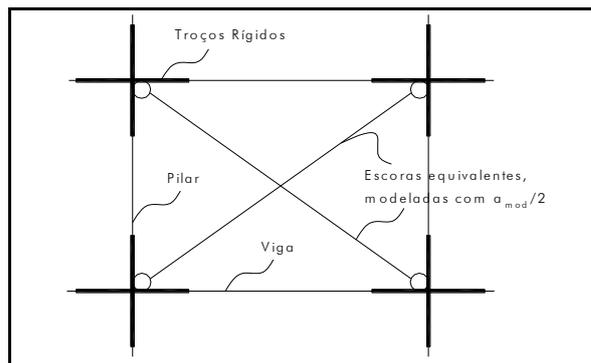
Modelo de elementos finitos proposto para representação de um quadro de pórtico preenchido com um painel de parede de alvenaria.
